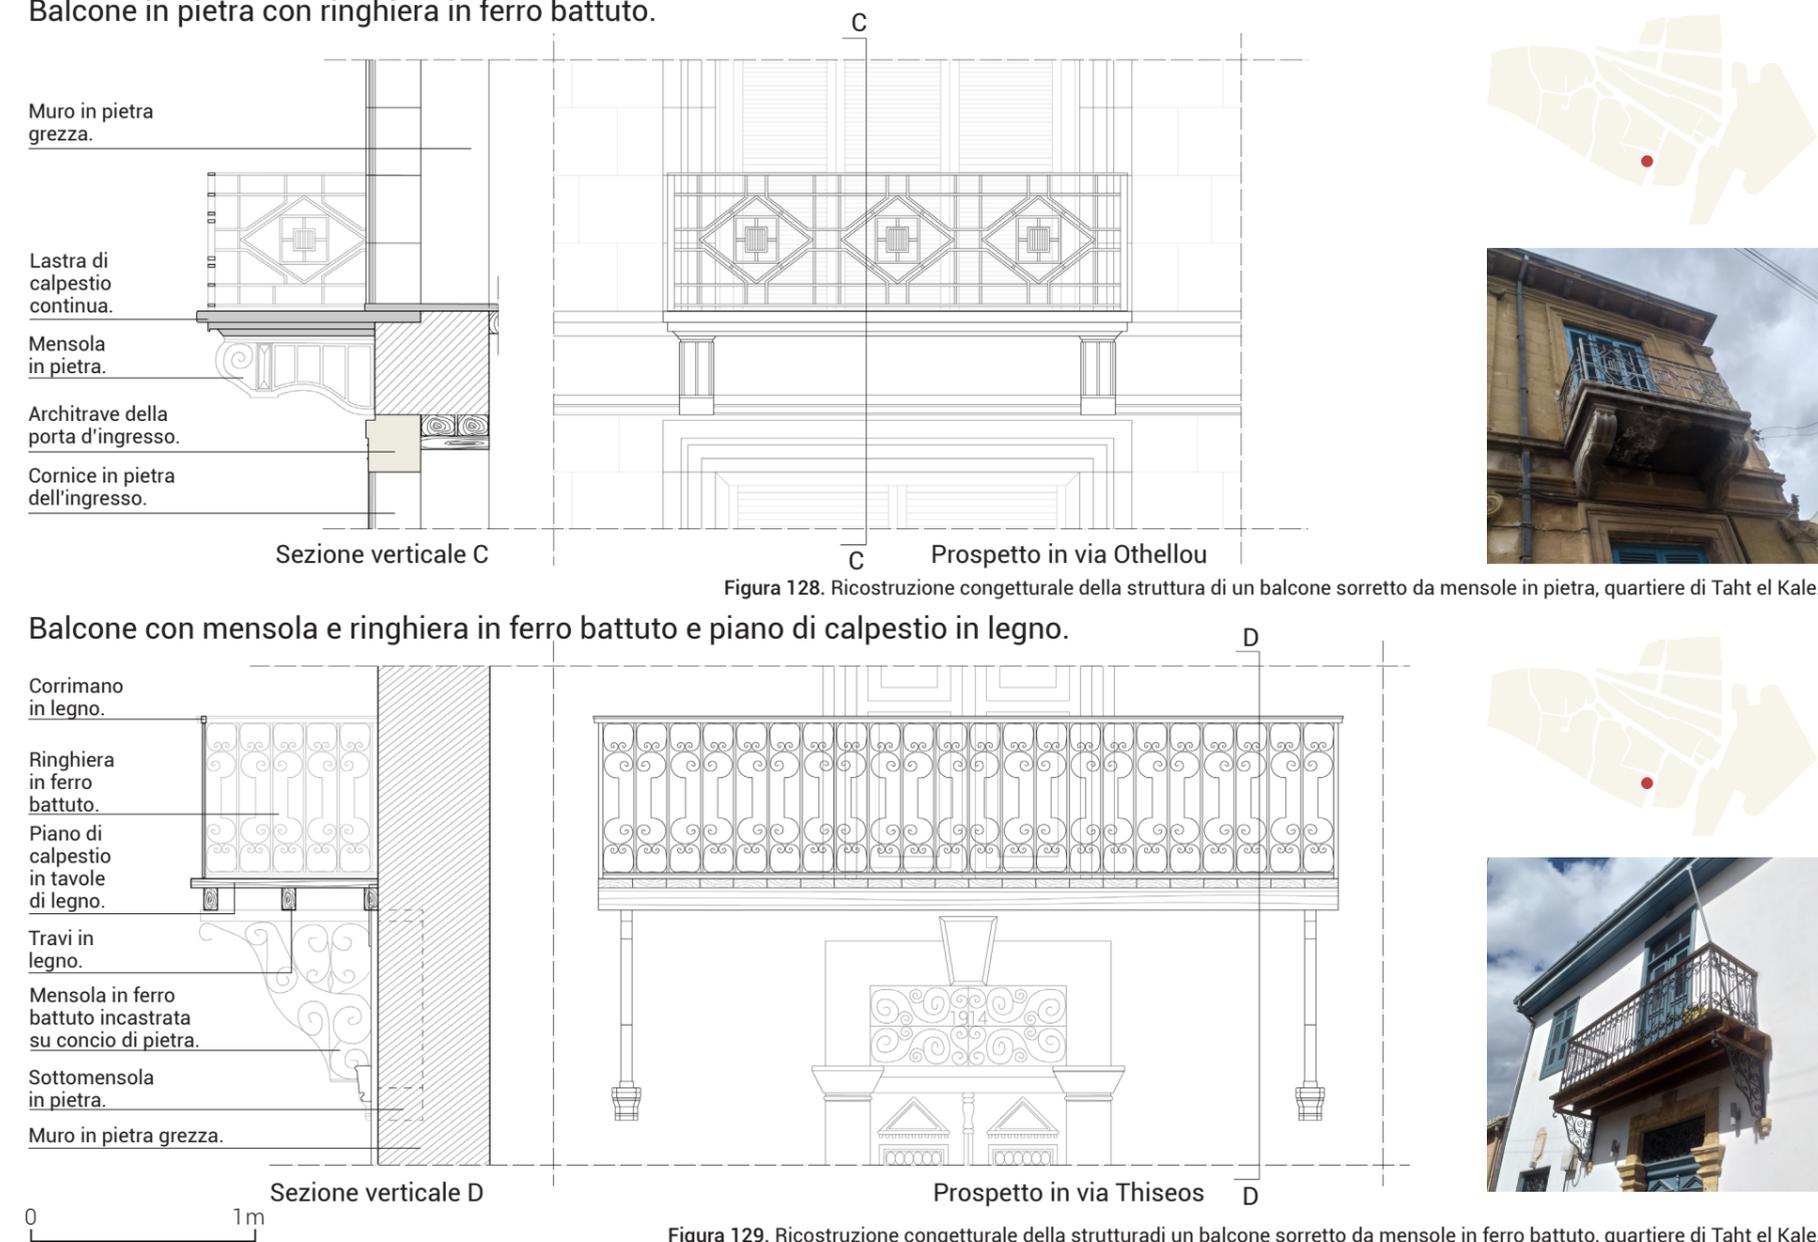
Ricostruzione congetturale della struttura di un balcone sorretto da mensole in pietra, quartiere di Taht el Kale.
